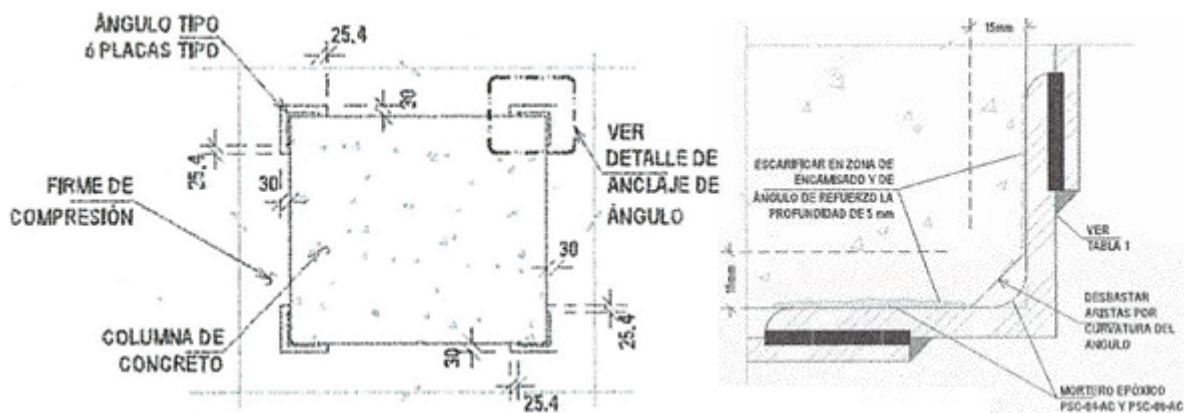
Detalles del refuerzo de las columnas de concreto con ángulos de acero y soleras del proyecto Scientology del Valle, (Gómez González, 2020).
